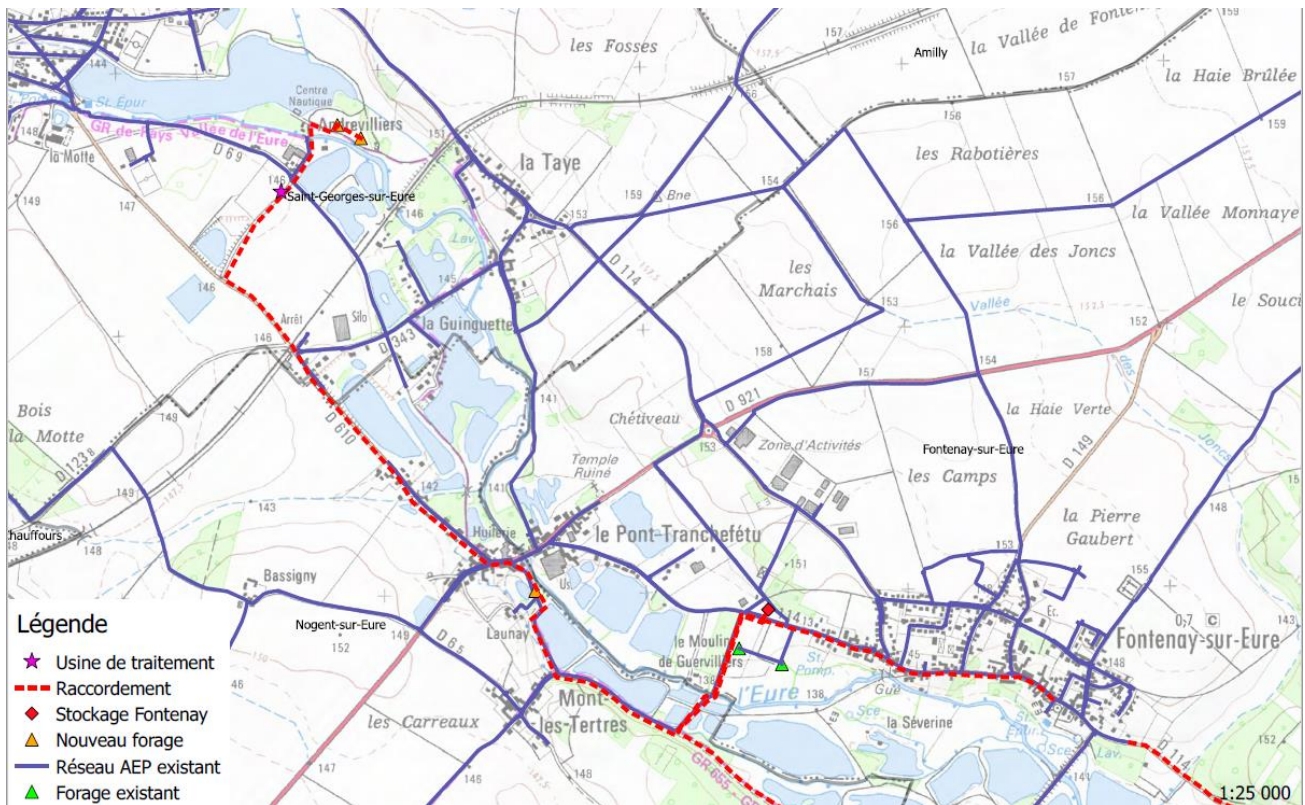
Projet de raccordement entre le site d'Andrevilliers et la station de Fontenay-sur-Eure
